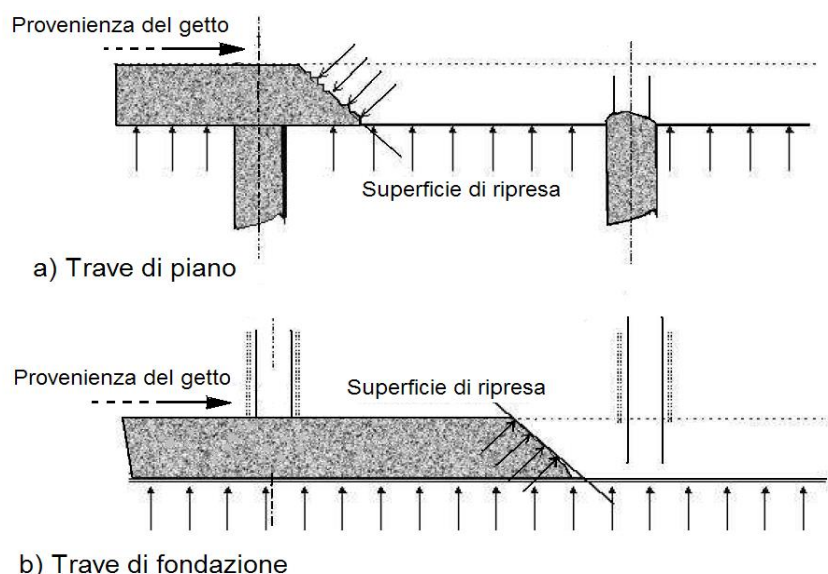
Modalità di ripresa del getto in travi di piano e di fondazione
